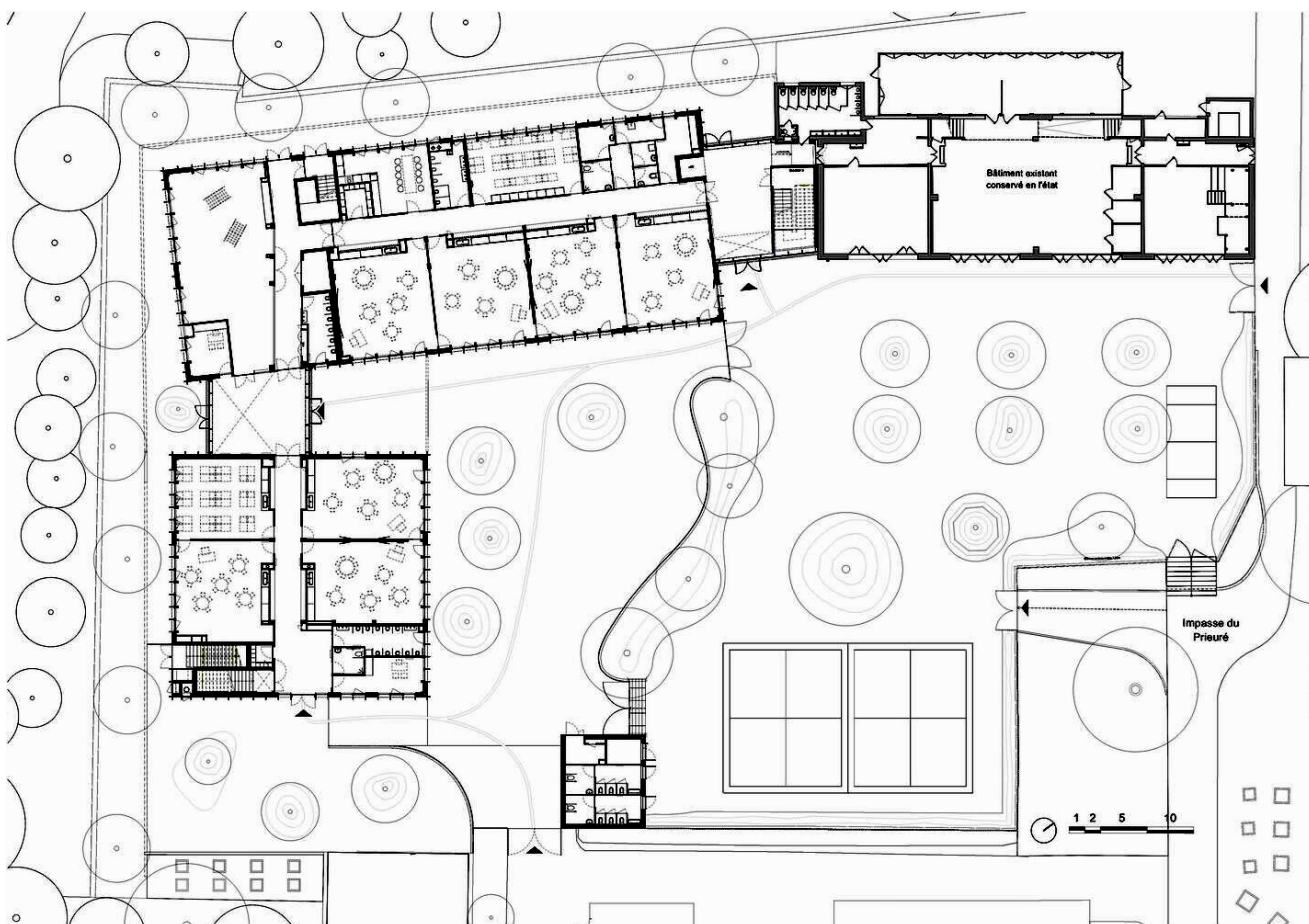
План 1-го поверху школи Les Violettes у Марей-Марлі, Франція. [20]
